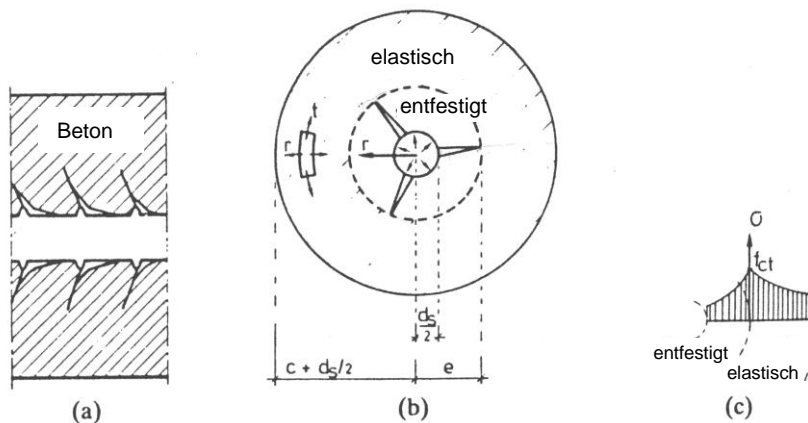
Bewehrungsstab mit umgebendem, teilweise gerissenem, Betonring: a) Längsschnitt mit Rissen, b) Querschnitt unter Angabe des Materialzustandes und c) Spannungsverteilung im Betonring (*Reinhardt und v. d. Veen 1991*)
